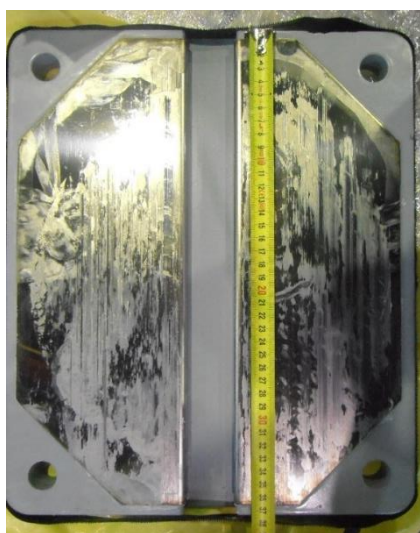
Aparelho de apoio do tipo *Pot Bearing* unidirecional desmontado em estaleiro
